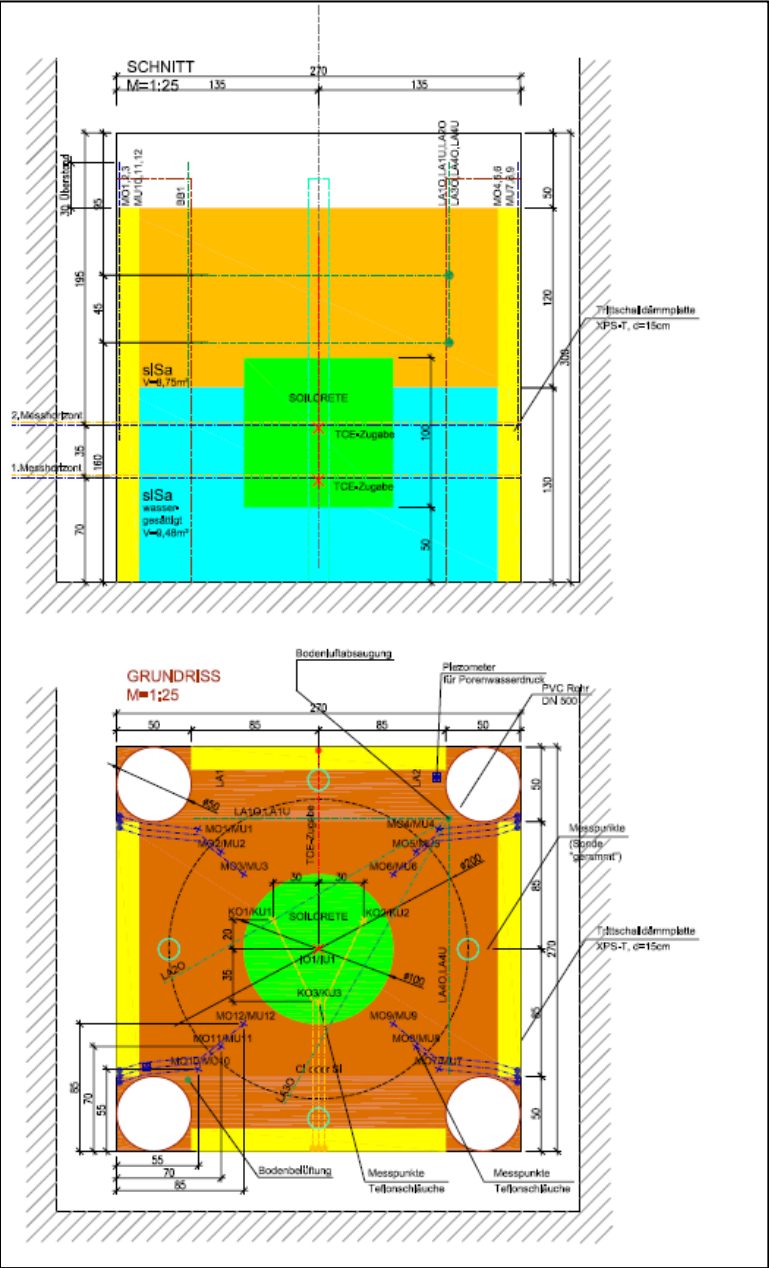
Versuchsaufbau (Grundriss und Schnitt) TU Graz
